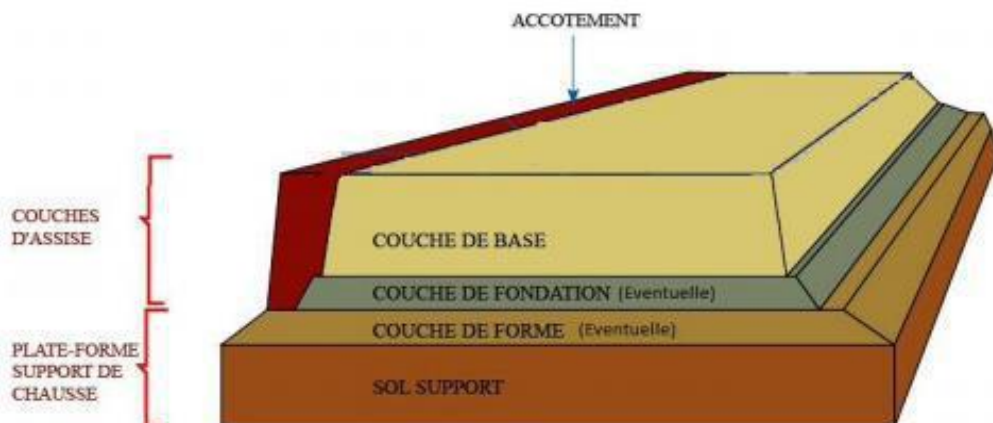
Coupe d'une structure de chaussée non revêtue
